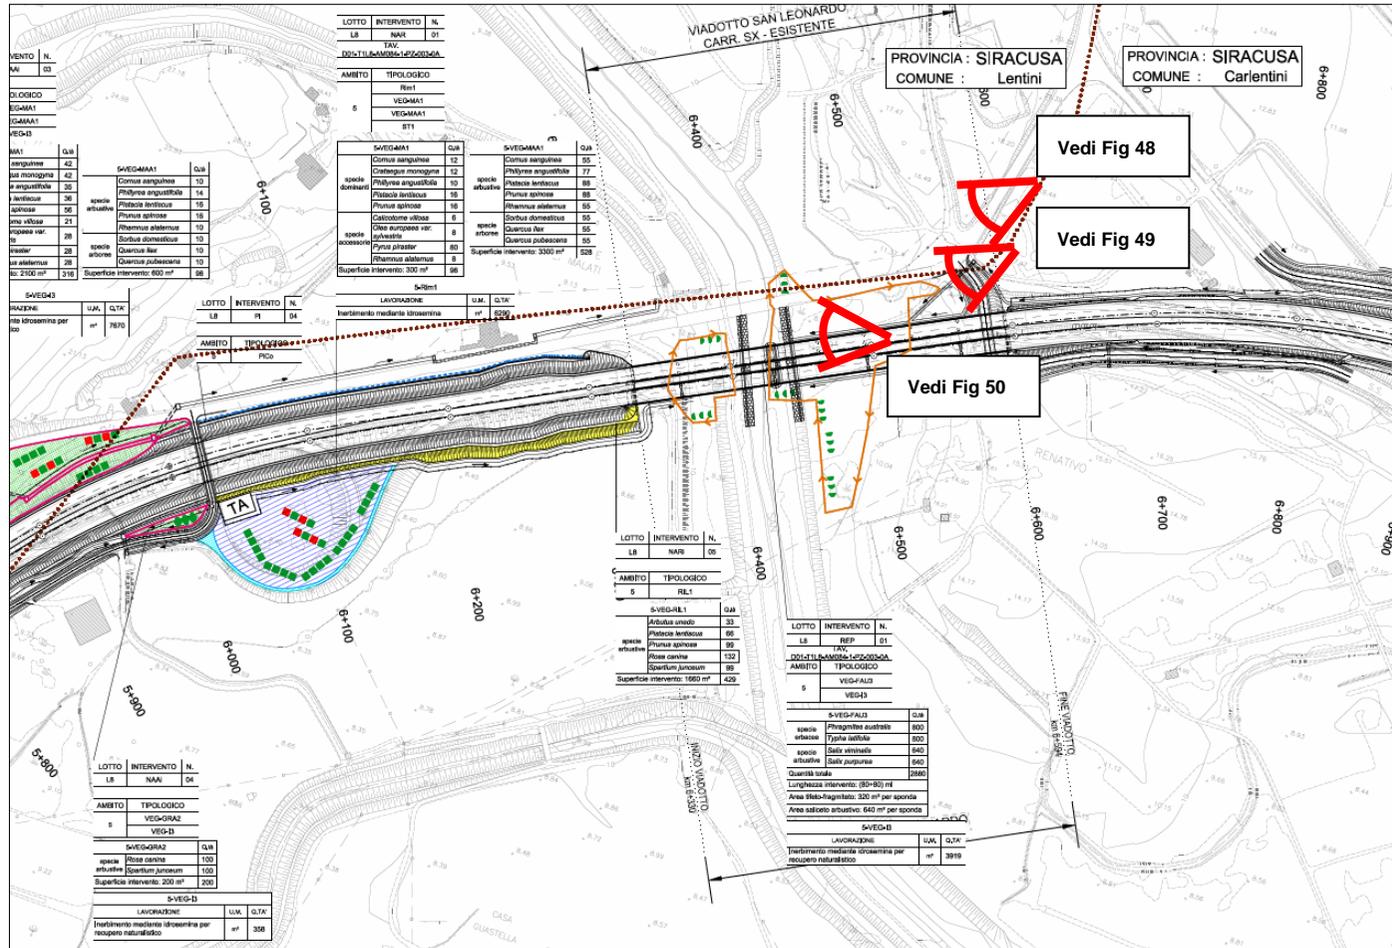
Stralcio planimetrico dell'area in corrispondenza del viadotto San Leonardo
